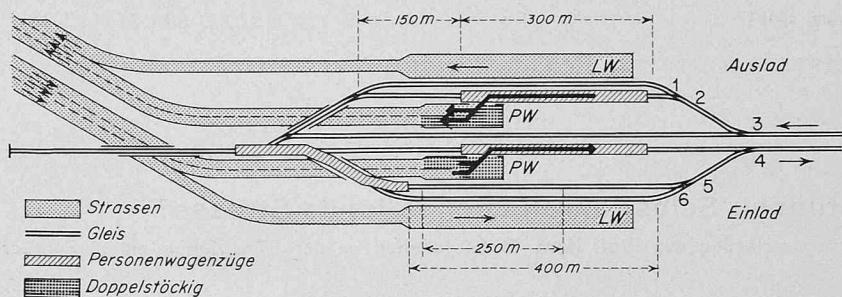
Stationsschema 2. Anlage getrennt in Ablad- und Einladseite mit zwischenliegendem Ausziehgleis. Auf jeder Seite ein Ladegleis mit Rampe für Lastwagen und zwei Ladegleise mit doppelstöckiger Rampe für Personenwagen. Sortierung des Verkehrs nach Fahrzeughöhe auf der ankommenden Strasse
